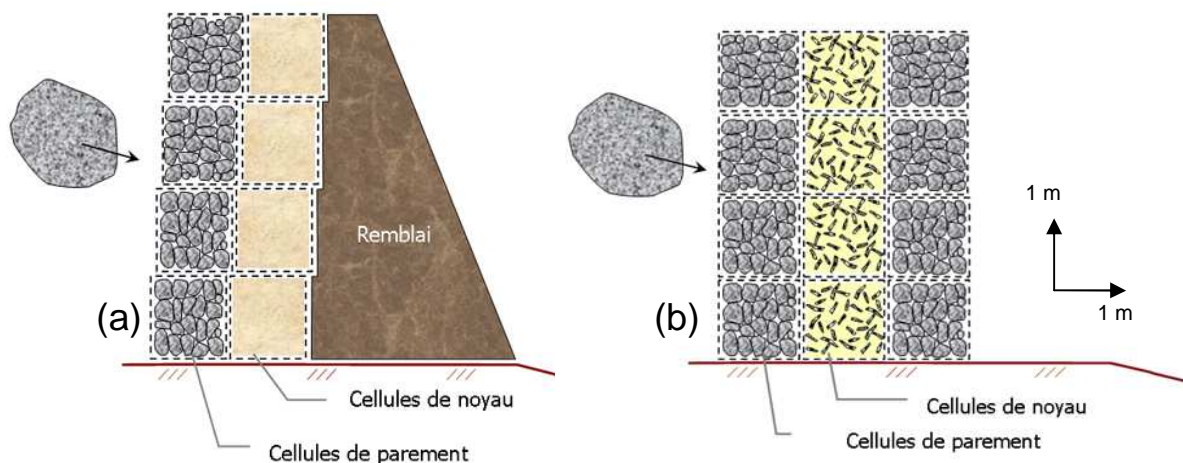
Structures testées (a) type 1 : un parement cellulaire appuyé contre un remblai, (b) type 2 : un mur sandwich cellulaire.
